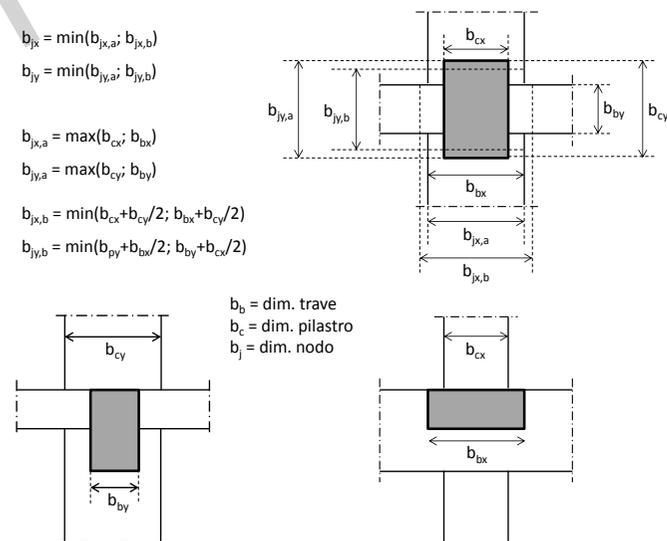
Dimensione efficace dei nodi trave-pilastro
